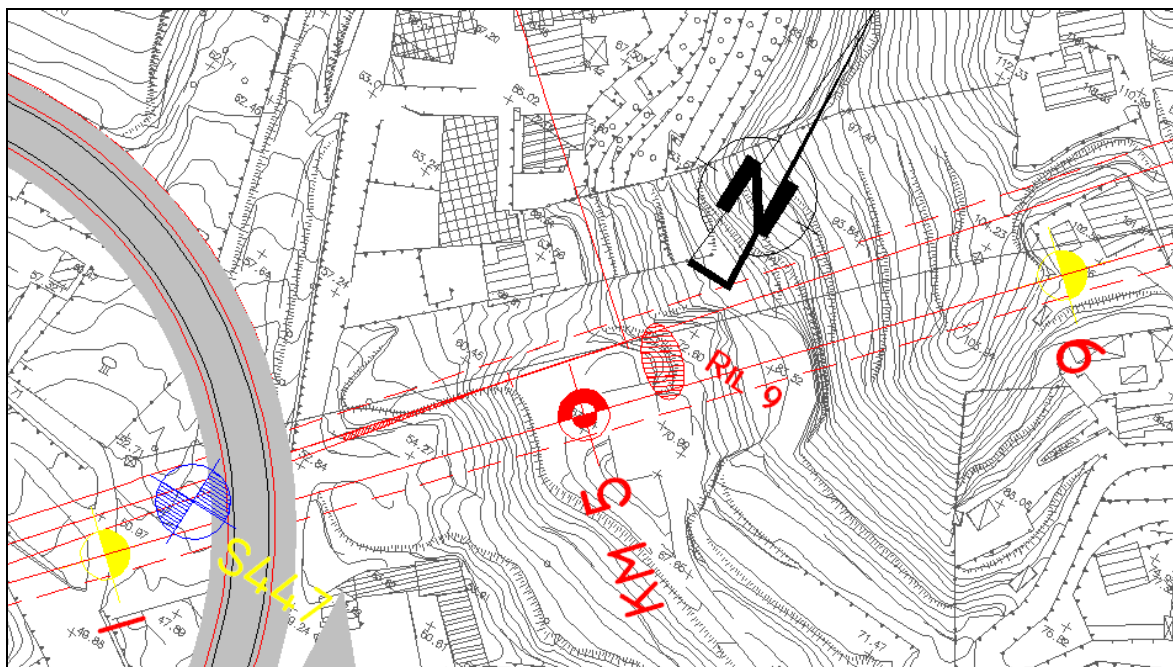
Ubicazione in planimetria dell'affioramento oggetto del rilievo geostrutturale
